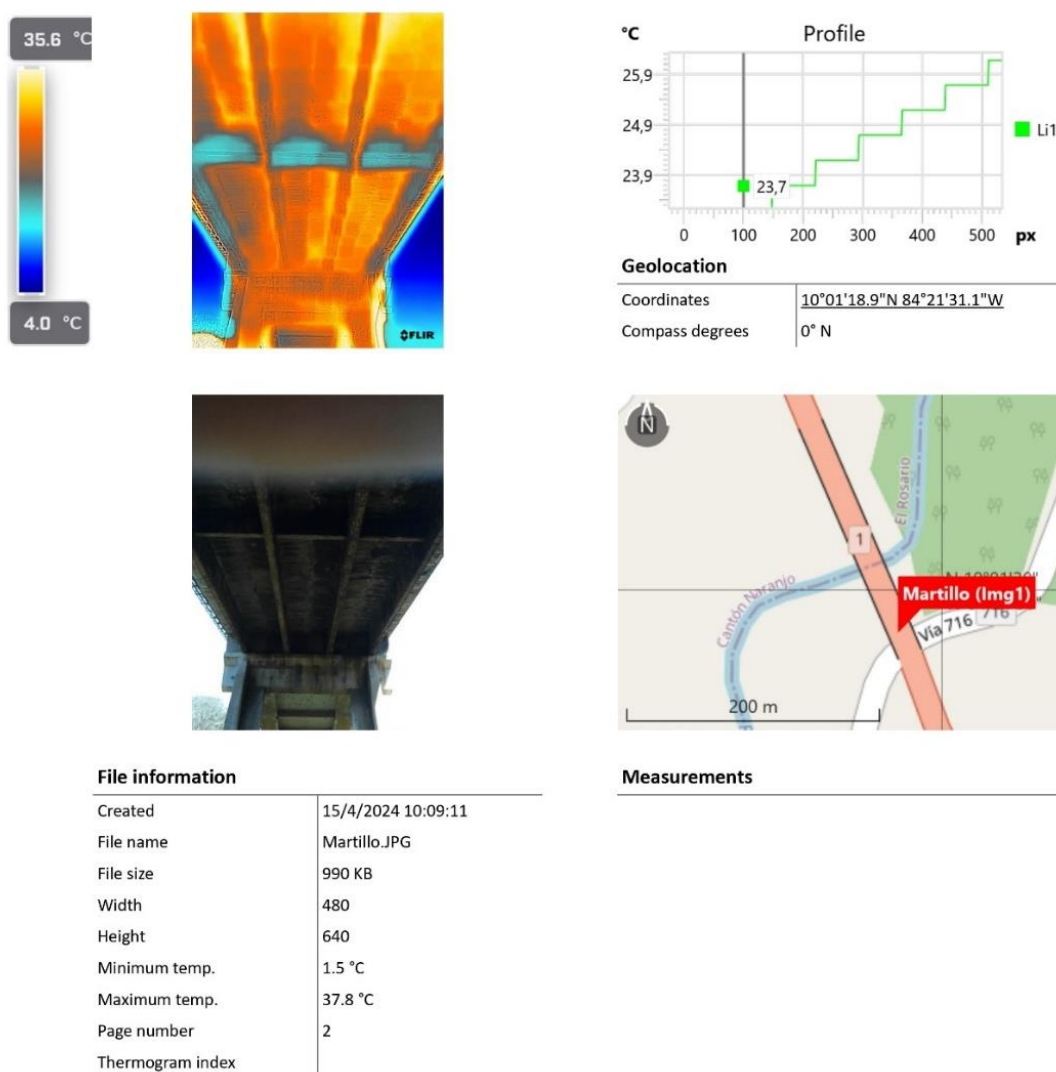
23 Reporte de descascaramiento en la viga diafragma de la sección No. 3
